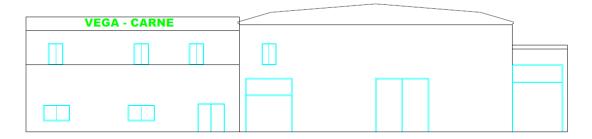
Croquis de alzado de la zona norte de la calle K
